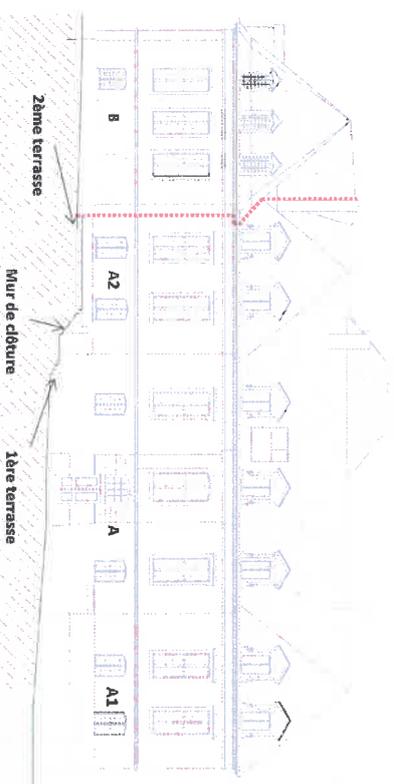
Elevation de la façade principale (Est) donnant sur la rue de la Monnaie composée de l'ancien hôtel de ville XVIII^{ème} (A) et du pavillon Sud (B).
